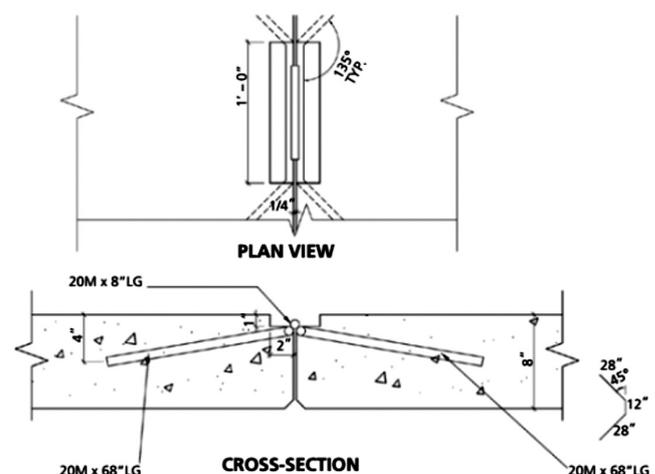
LIGAÇÕES ENTRE PAINÉIS DE PAREDE E LAJES
